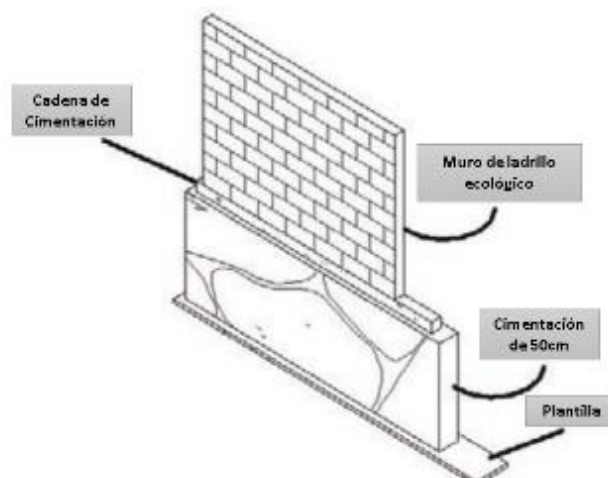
Cimentación y Muro en Área Canina y Felina.
